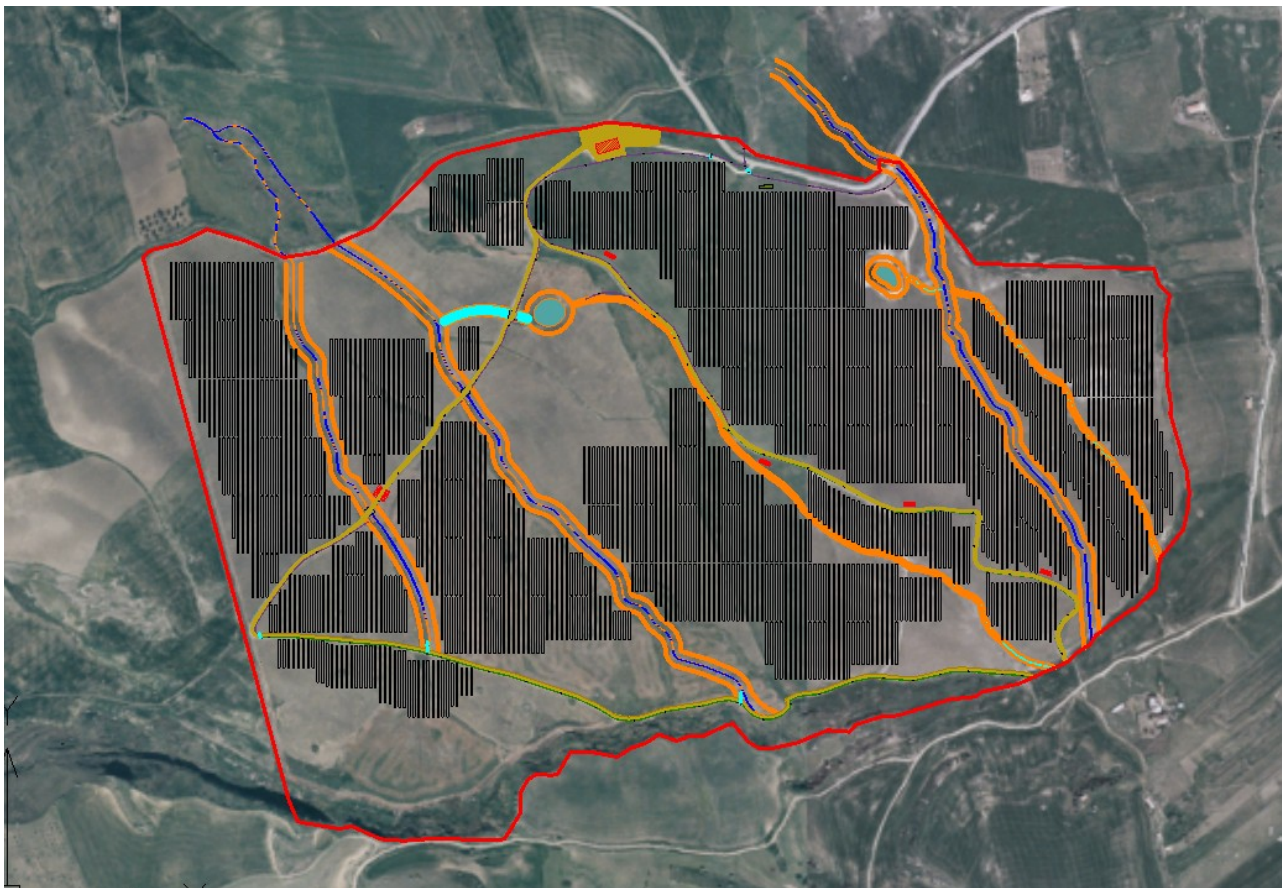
Stralcio elaborato con indicazione della viabilità da mantenere e dei canali con la fascia di rispetto da 10 metri prevista in progetto
